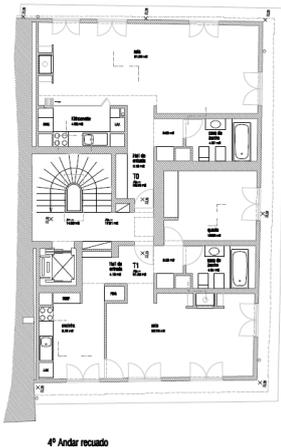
Planta de Arquitectura do 4º piso (recuado) proposta
